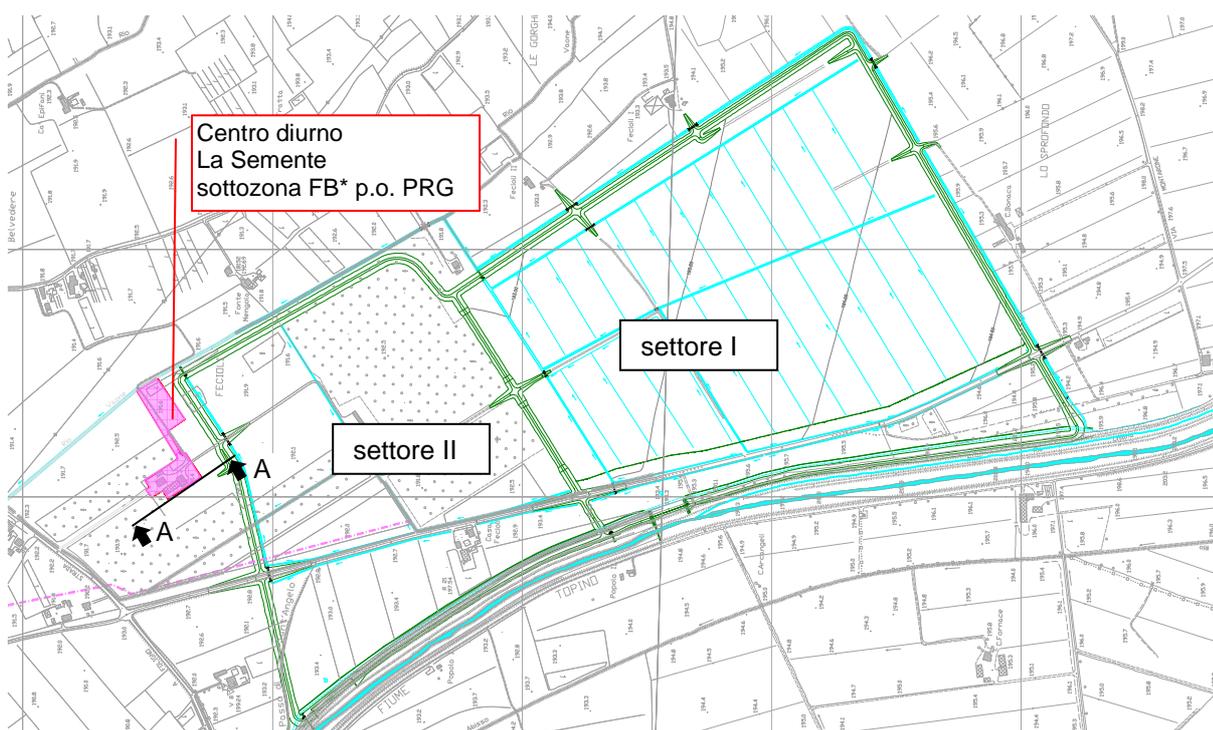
planimetria della cassa d'espansione con indicazione dei due settori.
